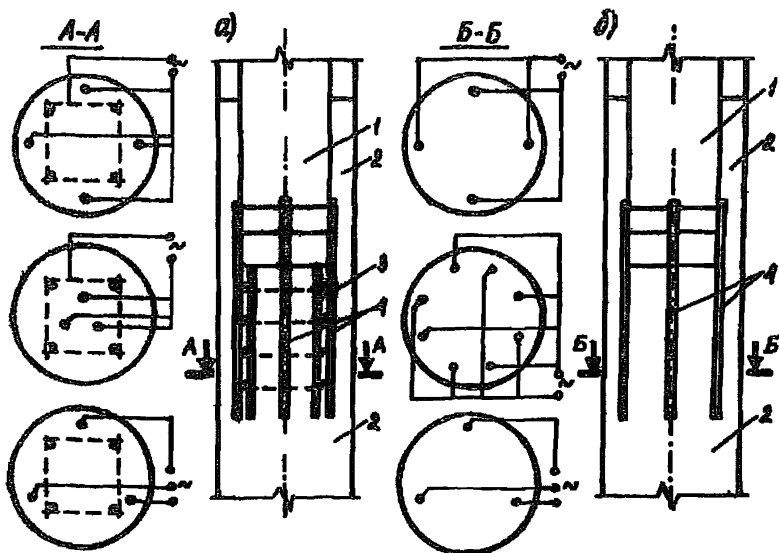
Схемы размещения и подключения электродов при прогреве бетона в стике комбинированных свай при наличии выпусков арматуры в теле сборного железобетонного элемента (а) и без выпусков (б); 1 - сборный элемент, 2 - монолитный бетон, 3 - выступающий арматурный каркас, 4 - стержневые электроды
